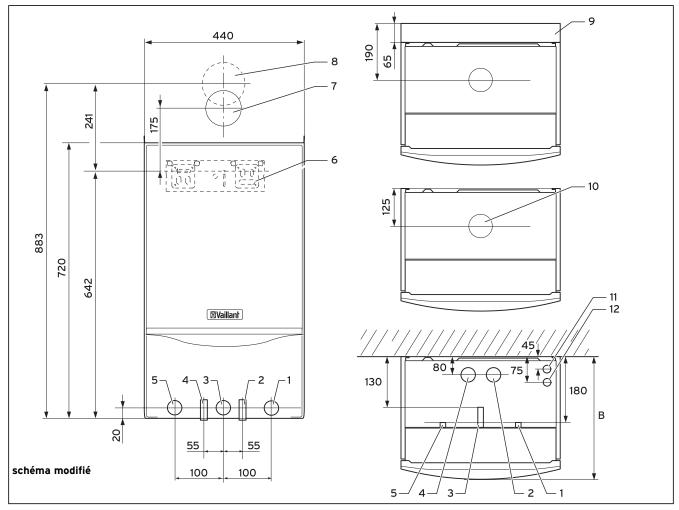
Dimensions de raccordement en mm (appareil VC)
